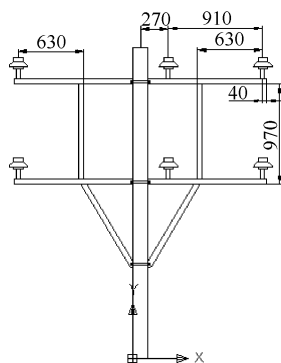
标注左边绝缘子与横杆支架之间的尺寸
